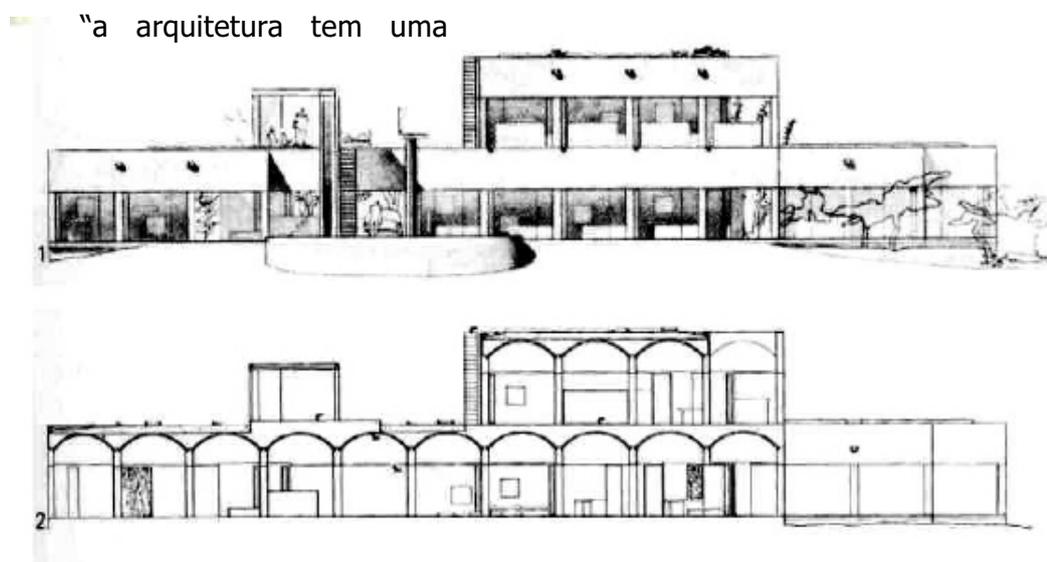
Casa Sarabhai em Ahmedabad na Índia (1955). Fachada e corte - as abóbadas não aparecem na fachada, são fechadas pela testeira reta "embutindo" a arcada;
